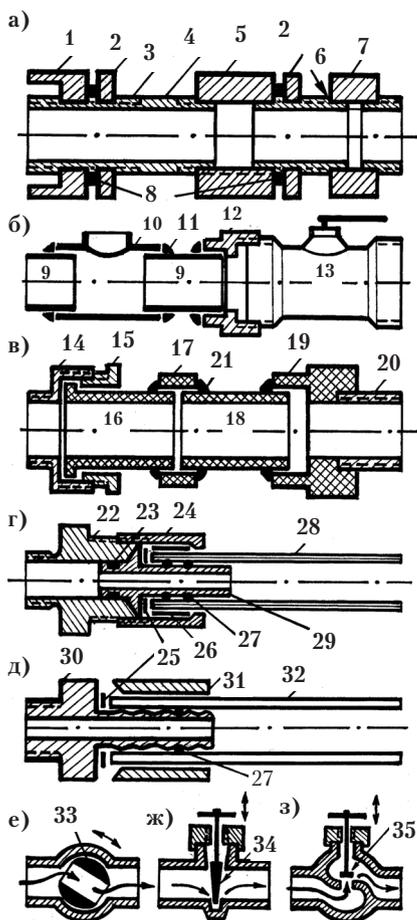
Виды трубопроводов: а – стальной (оцинкованный) на резьбовых соединениях, б – медный на паяных соединениях, в – полипропиленовый на сварных или на разборных резьбовых соединениях, г – металлопластиковые (полиэтилен-алюминий) на резьбовых обжимных фитингах, д – полиэтиленовые на прессующих фитингах, е – кран, ж – задвижка, з – вентиль. 1 – штуцер аппарата, 2 – гайка уплотнительная, 3 – сгон (удлиненная резьба на трубе), 4 – труба стальная сварная или бесшовная (в том числе оцинкованная), 5 – муфта разъемного соединения, 6 – резьбовое соединение на пакле, 7 – муфта неразъемного соединения, 8 – герметизация намоткой пакли, 9 – медная труба, 10 – тройник (или иной подсоединяемый элемент, например, муфта), 11 – пайка, 12 – припаянный штуцер (медный) с резьбой, 13 – винчивающийся элемент (например, кран), 14 – металлический элемент присоединяемый, 15 – гайка прижимная уплотняющая, 16 – труба полипропиленовая с отбортовкой (развальцовкой, утолщением на торце), 17 – муфта пропиленовая, 18 – труба пропиленовая погонажная, 19 – муфта с переходом на металл (приварной полипропиленовый наконечник с вплавленным металлическим крепежом (резьбовым, фланцевым, с внешней или внутренней резьбой и т. п.)), 20 – вплавленный (впрессованный) резьбовой штуцер, 21 – сварное соединение, 22 – муфта (фитинг) из штампованной латуни для перехода от пластика на металл, 23 – резиновое кольцо, 24 – затяжная гайка, 25 – изолирующая прокладка, 26 – обжимающее кольцо разрезное, 27 – резиновые кольца, 28 – металлопластиковая труба, 29 – наконечник (штуцер) из латуни с двумя резиновыми уплотнительными кольцами, 30 – муфта (фитинг), 31 – уплотняющая гильза, напрессованная на пластиковую трубу движением влево до упора к муфте, 32 – пластиковая или металлопластиковая труба, 33 – шар (или конус) со сквозным проходным отверстием (вид сверху со стороны ручки вращения), 34 – клиновидная задвижка, перемещающаяся вверх-вниз за счёт вращения ручки, 35 – шток с резьбовым подпятником, перекрывающим седло проходного отверстия.
